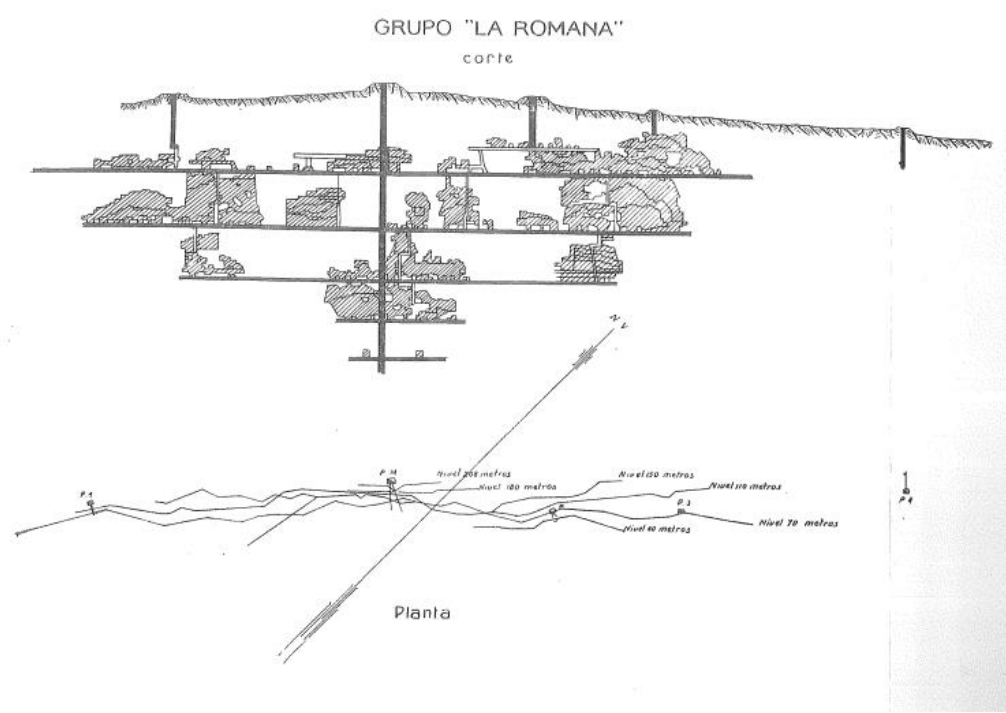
Sección longitudinal y planta de la explotación en La Romana
